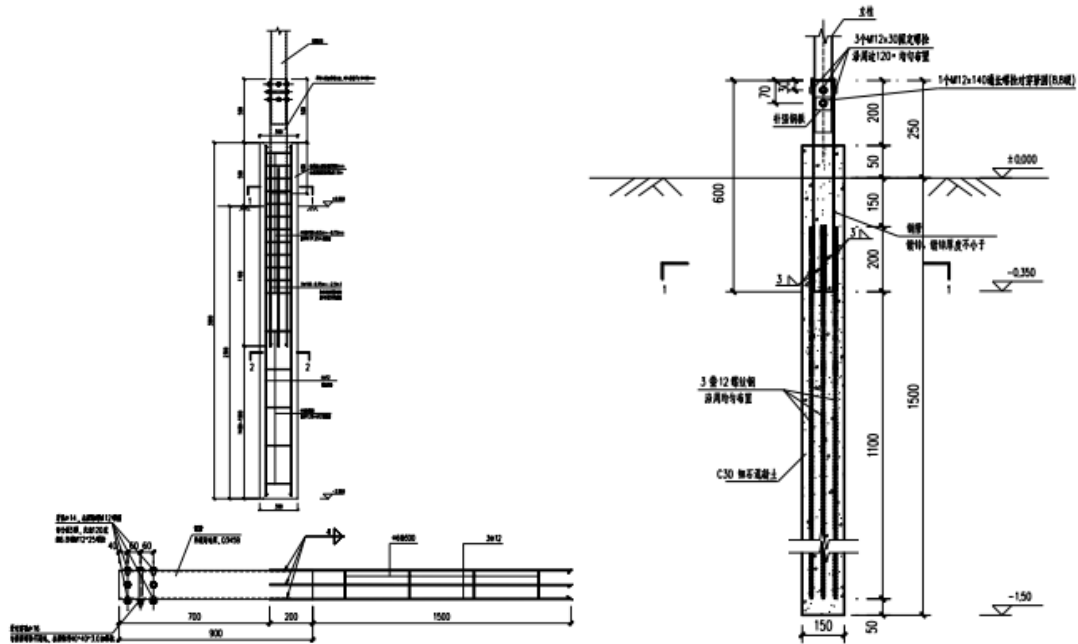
支架基础及预埋件体型图（左单立柱，右双立柱）
